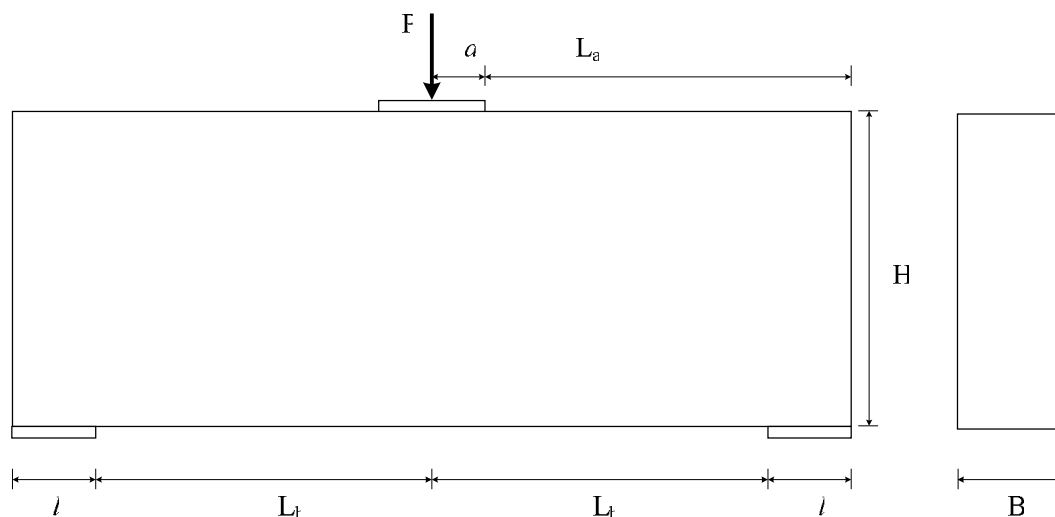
Viga parede simplesmente apoiada com carregamento centrado do ACI 318-05 (2005).
